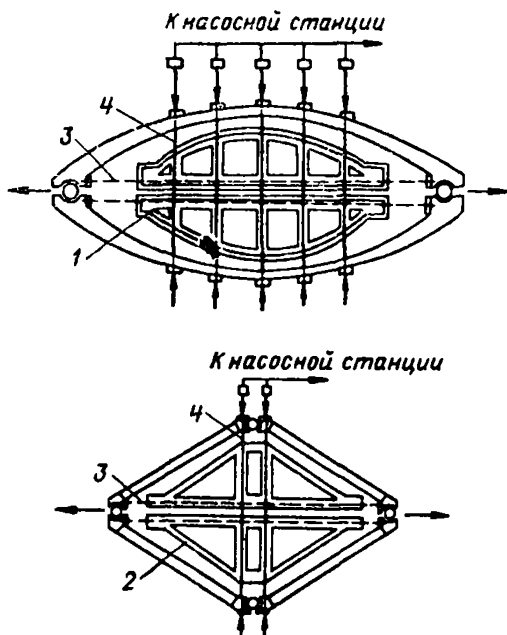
Распорный стенд для двухосного натяжения арматуры
